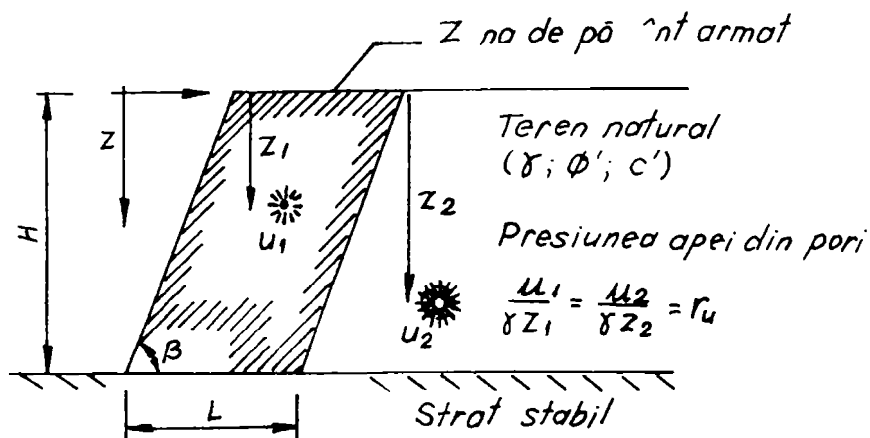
Structura de pământ armat: schema de ansamblu.
